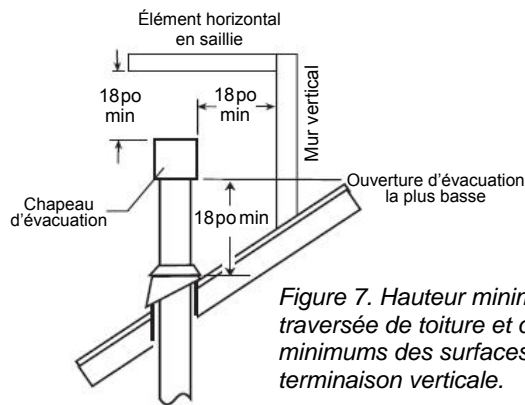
Hauteur minimale de traversée de toiture et dégagements minimums des surfaces adjacentes - terminaison verticale.
